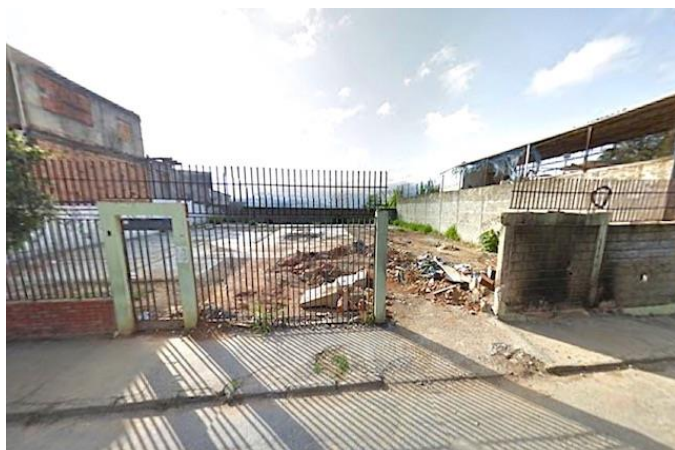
Vista geral do terreno localizado na Rua Centro Social Nº 536, onde será construída a UBS Cabana.
